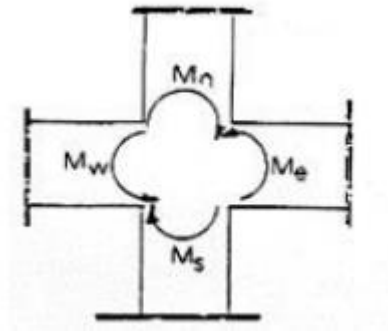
Première cas de zone nodale (Poutre principale)
